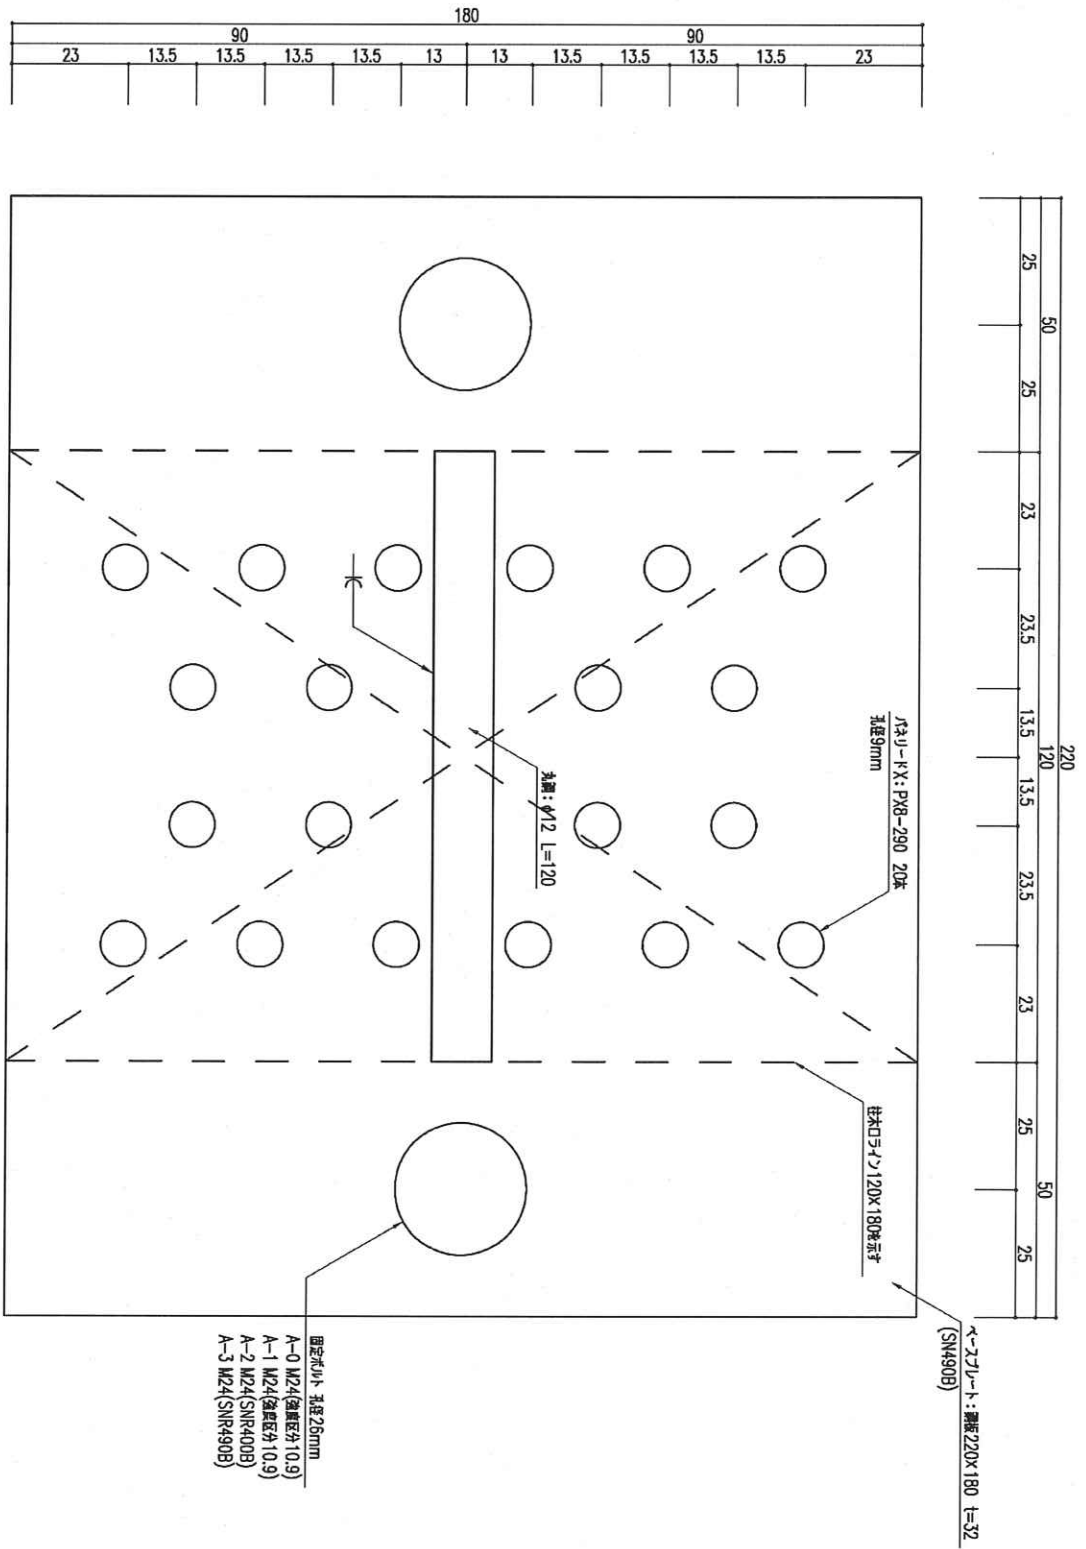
試験法 A 柱脚金物詳細図 (裏面) (単位: mm)
